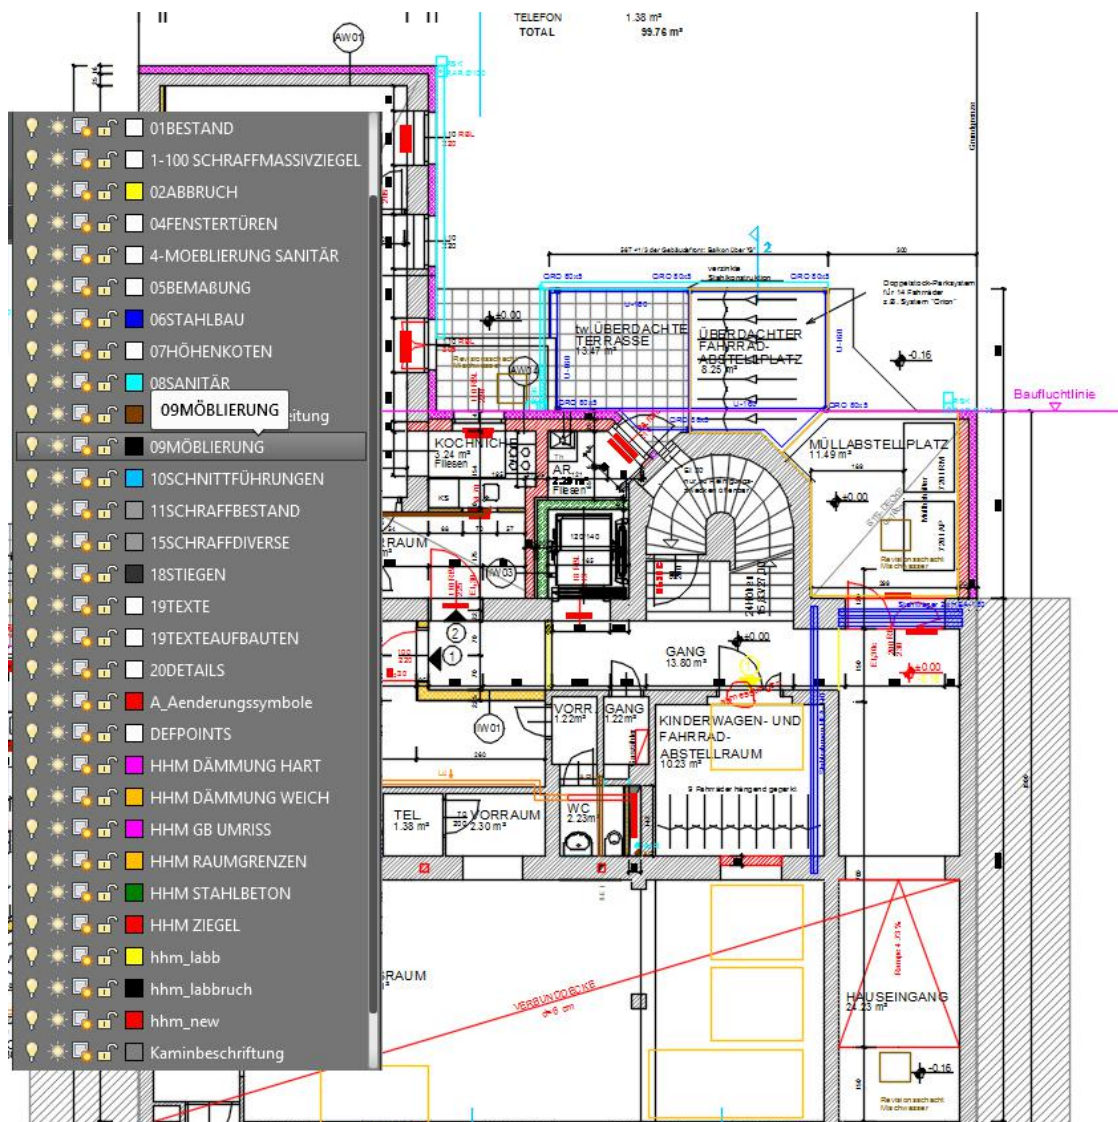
Ausschnitt eines Grundrissplans mit allen enthaltenen Informationen. Über dem Plan eingefügt wurde links in der Abbildung ein Ausschnitt der enthaltenen Ebenen.
